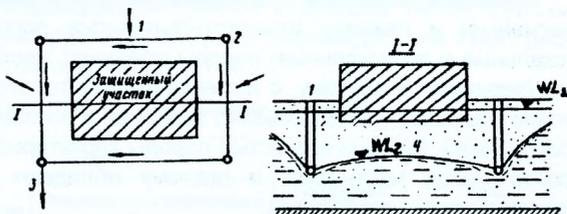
Береговой дренаж (план и разрез): 1 - береговая дрена; 2 - пониженный уровень.
